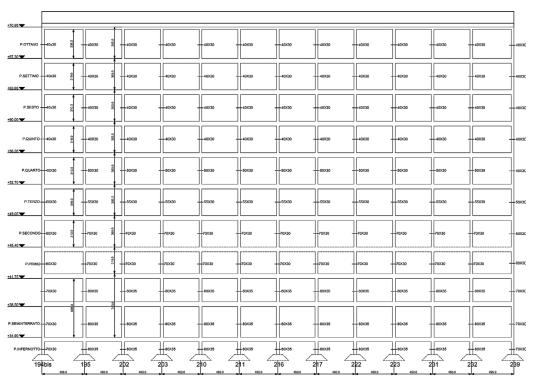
Sezione Strutturali Telai Longitudinali Tipo.
